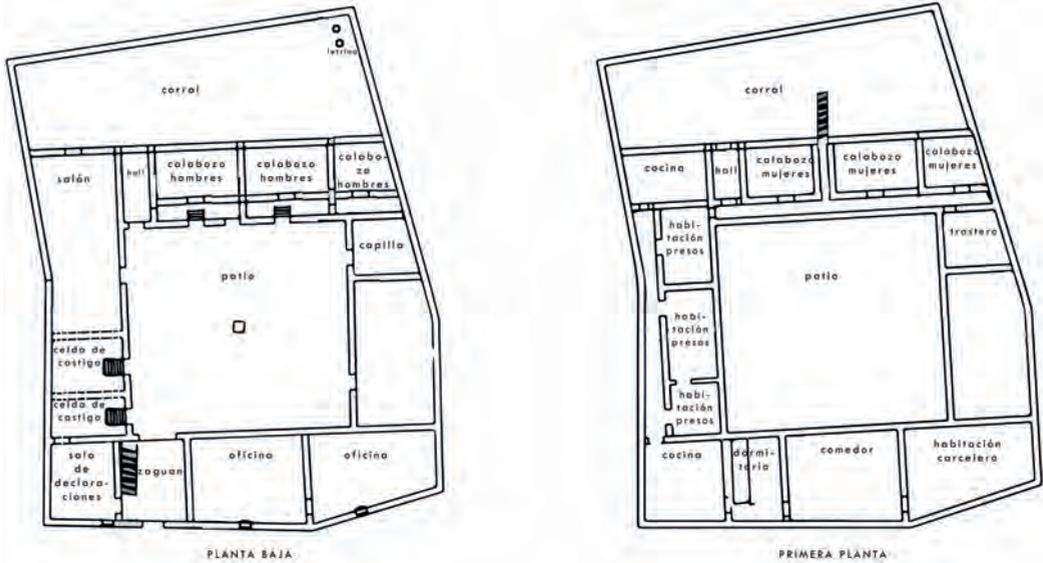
Hipótesis de planos, planta baja y primera planta, entre 1945 y 1966.
